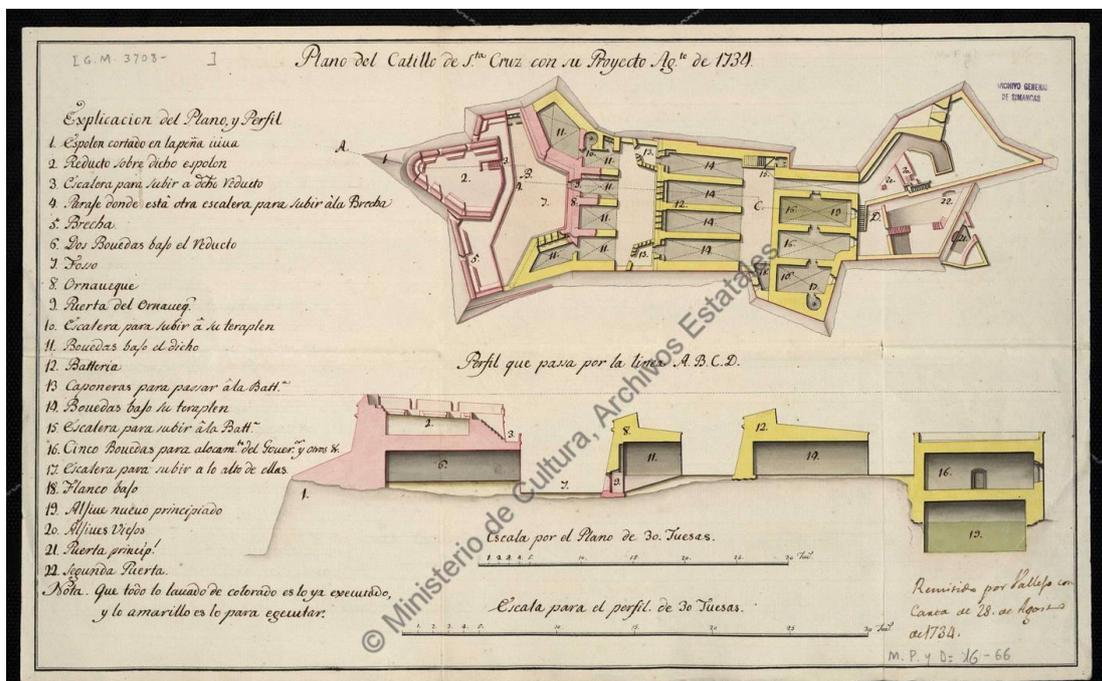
13 Plan et coupe verticale de la forteresse de Santa Cruz de la place d'Oran, Algérie, 1734. (Archives Générales de Simancas)
